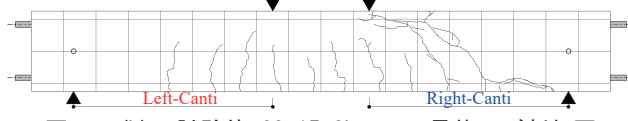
(b) 試験体 GS-15-Shear の最終ひび割れ図
